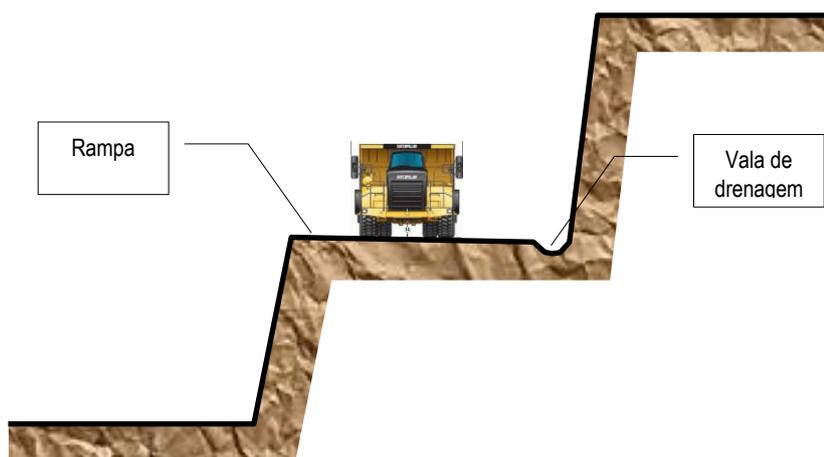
Perfil esquemático da implantação das valas de drenagem nas rampas.
